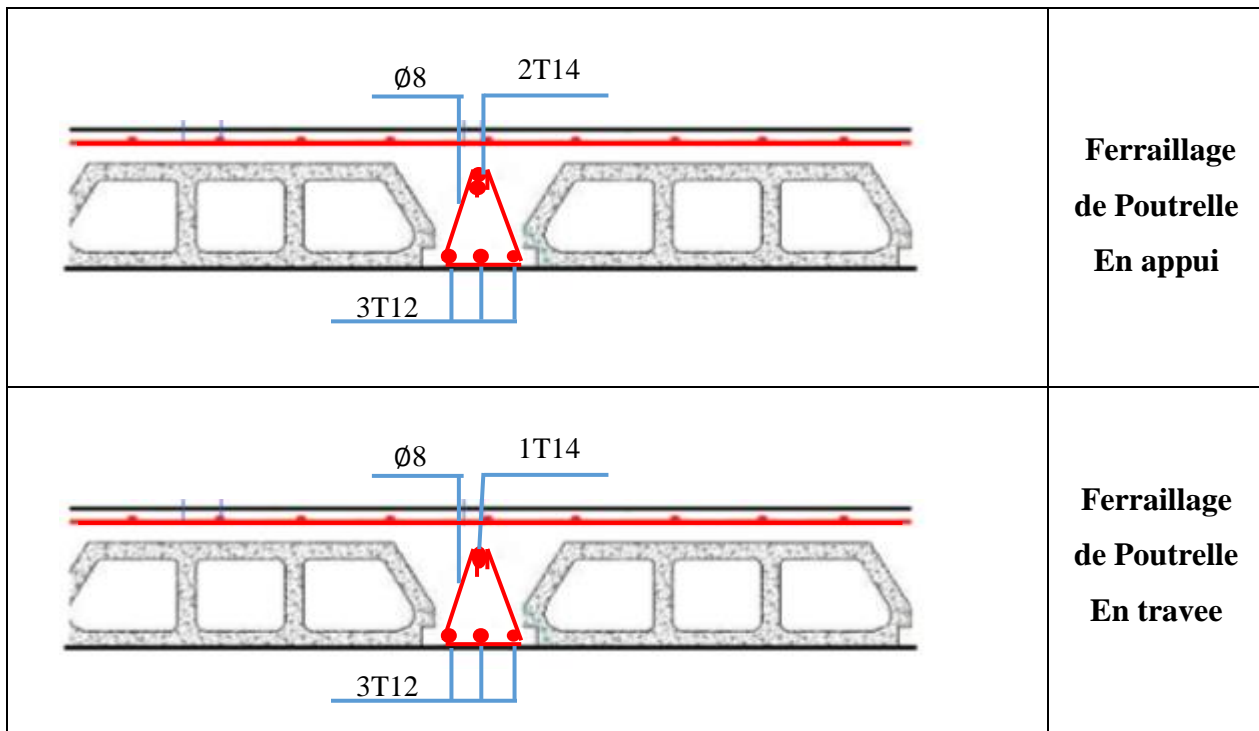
Schéma de ferrailage des poutrelles type 05.
